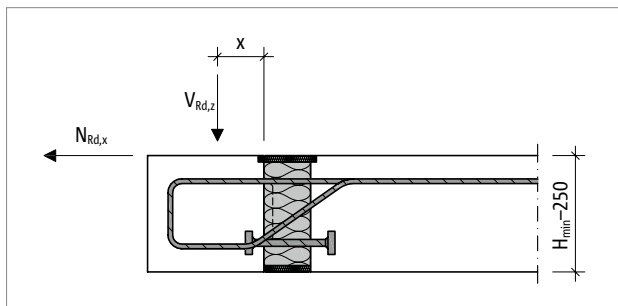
Schöck Isokorb® T Typ OP: Abstand des Lasteinleitungspunktes x (Lastabstand)
